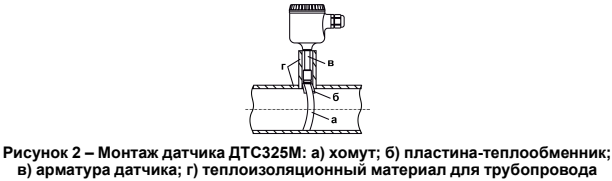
Монтаж датчика ДТС325М: а) хомут; б) пластина-теплообменник; в) арматура датчика; г) теплоизоляционный материал для трубопровода
